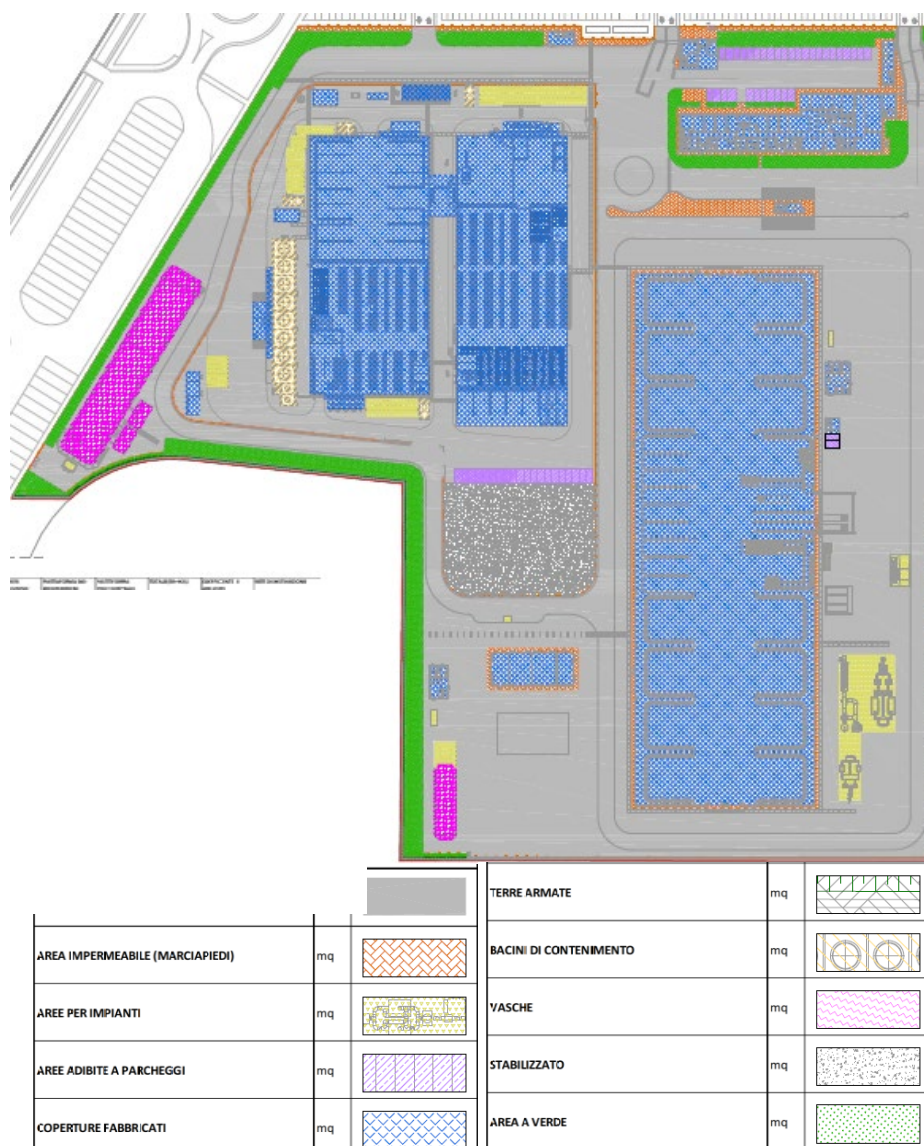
Planimetria generale delle coperture (Stralcio Elaborato CO 05 RA VA 01 D1 PL 55.00 - PLANIMETRIA GENERALE COPERTURE)
